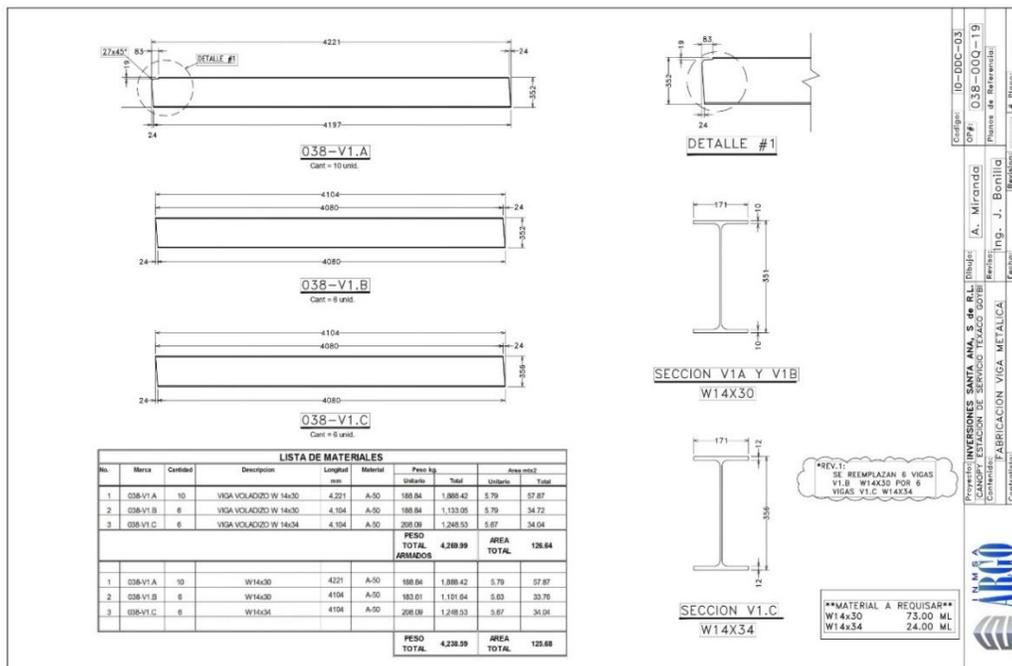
Plano de fabricación vigas voladizo implementando perfil W14x34
